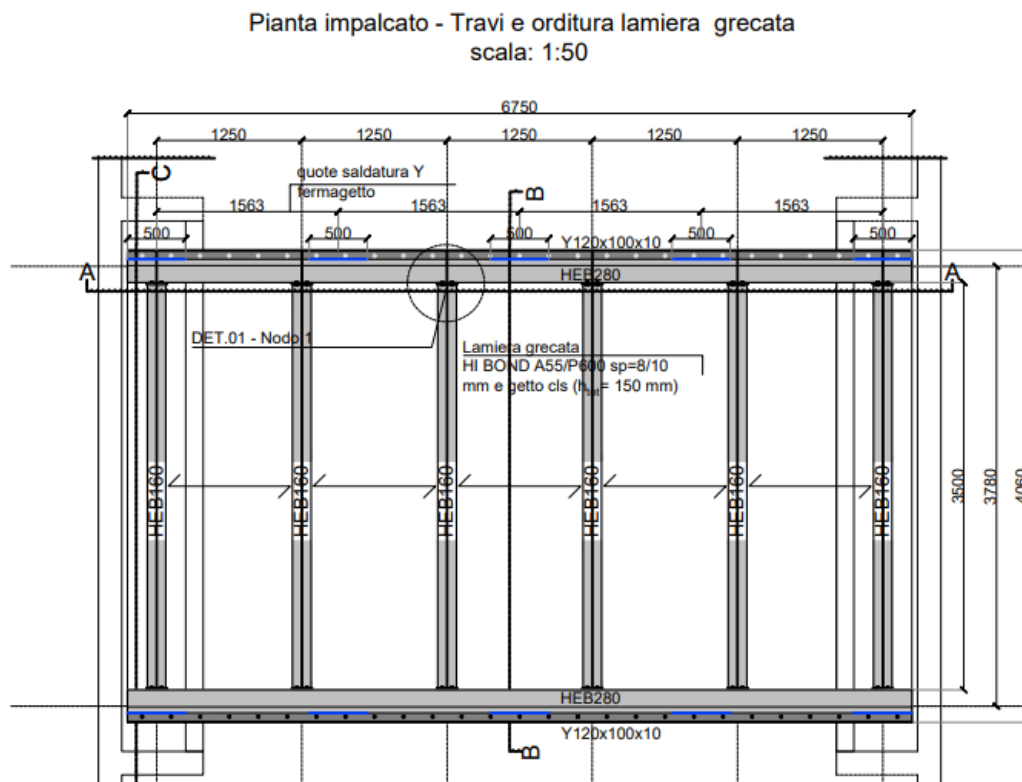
Pianta impalcato – Ponte pedonale 1C e 1D
